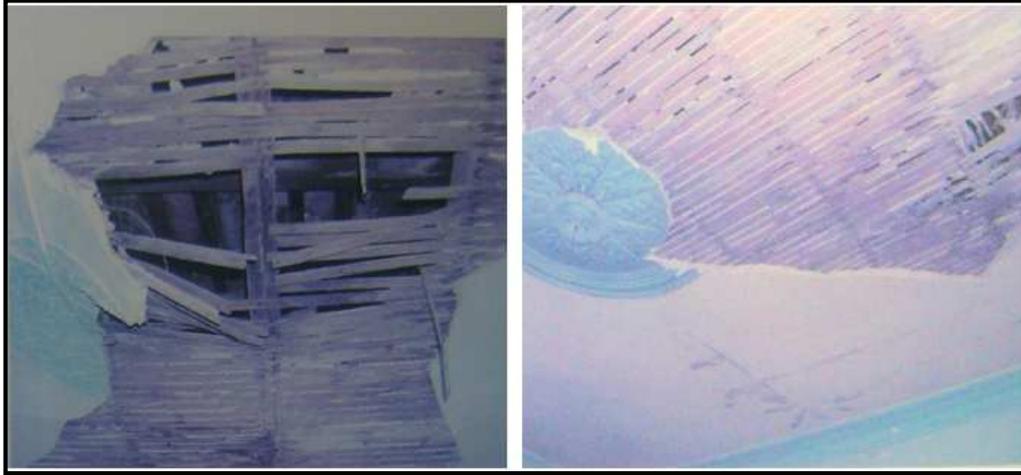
115 : Maison Ingliz Bey : Planchers traditionnels en bois (niveau étage). Source : le propriétaire de la maison.
